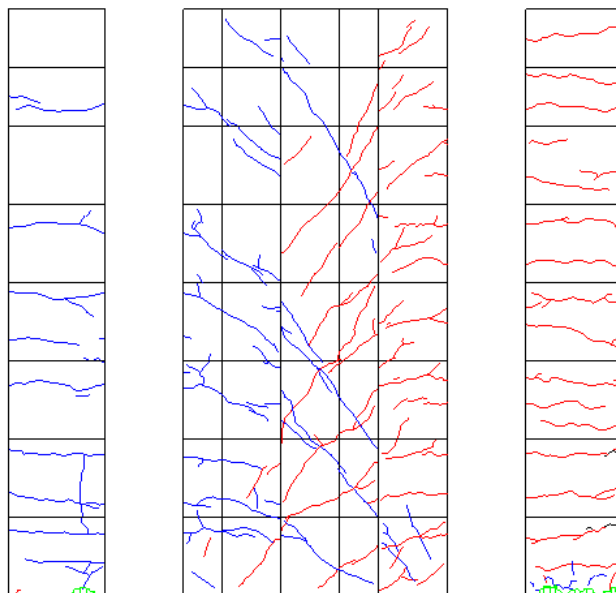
R=1/50 ひび割れ図
